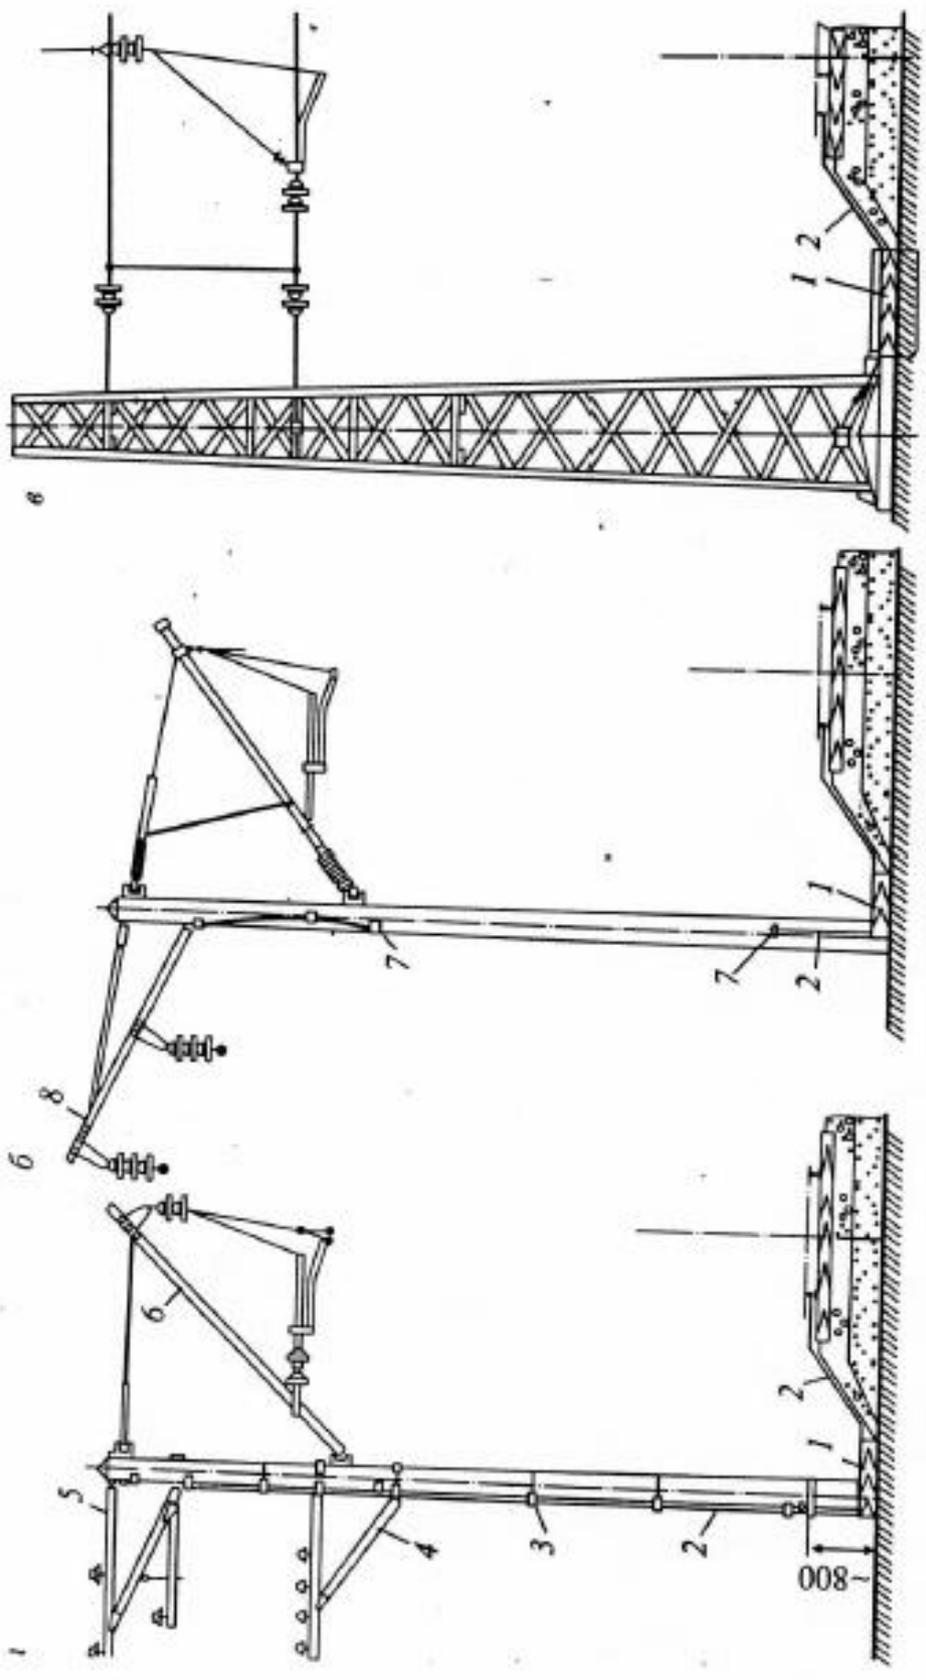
Схема заземлений на железобетонной и металлической опорах: *a* — железобетонная опора при постоянном и переменном токе; *б* — железобетонная опора при переменном токе (ранее применяемая схема); *в* — металлическая опора; 1 — полушпала; 2 — заземляющий проводник; 3 — деревянная или полимерная прокладка; 4 и 5 — кронштейн для проводов ВЛ 0,4 и ВЛ 6 (10) кВ; 6 — консоль; 7 — выводы заземляющего проводника; 8 — кронштейн провода ДПР
